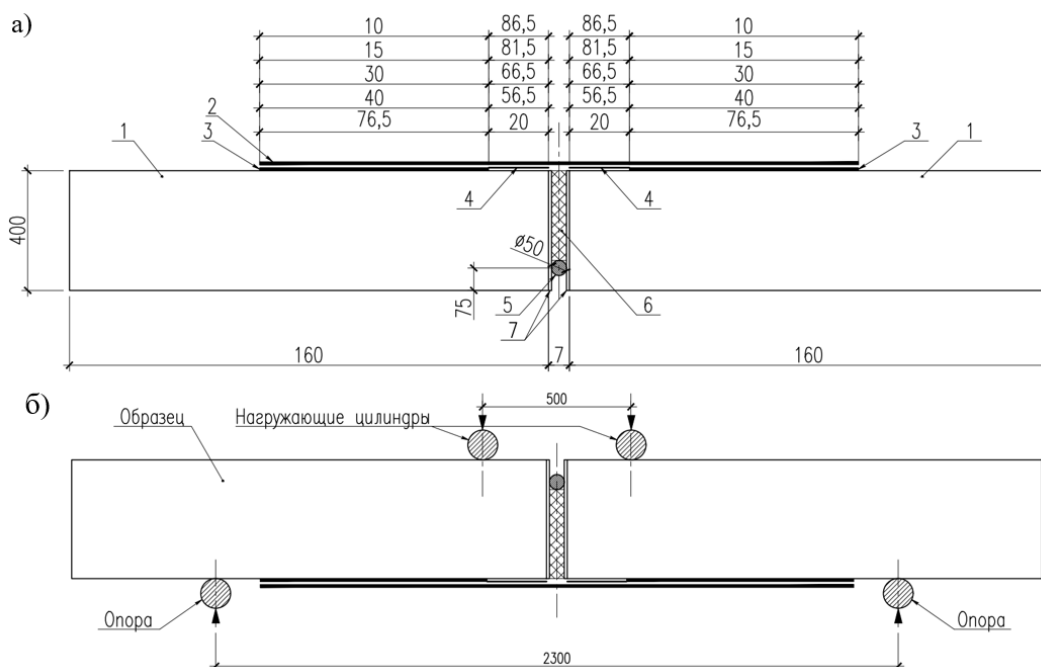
Схема шарнирного образца из двух призм (а) и схема нагружения (б)
